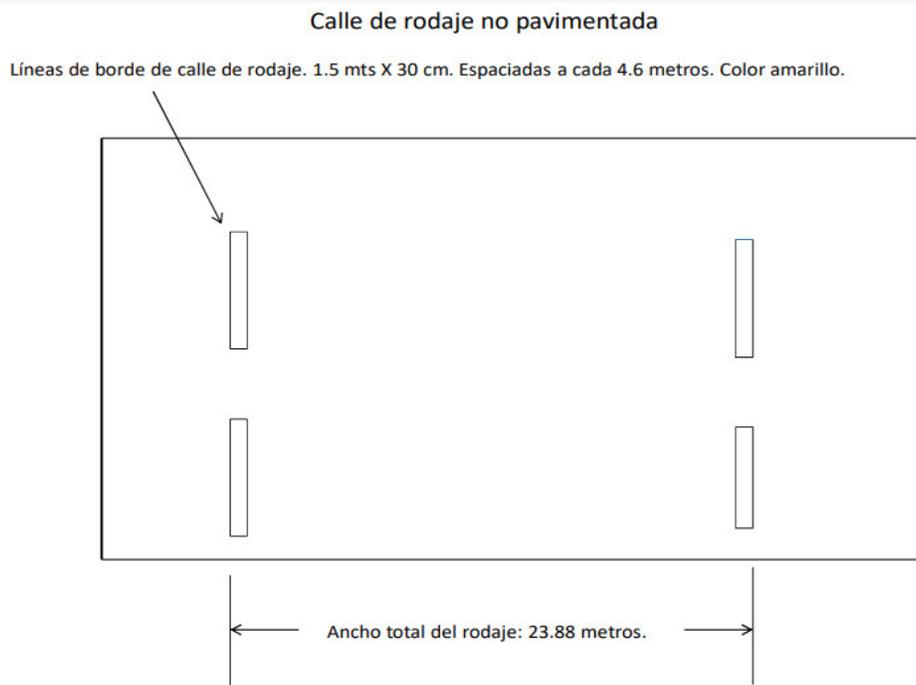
DETALLES DE CALLE NO PAVIMENTADA.
